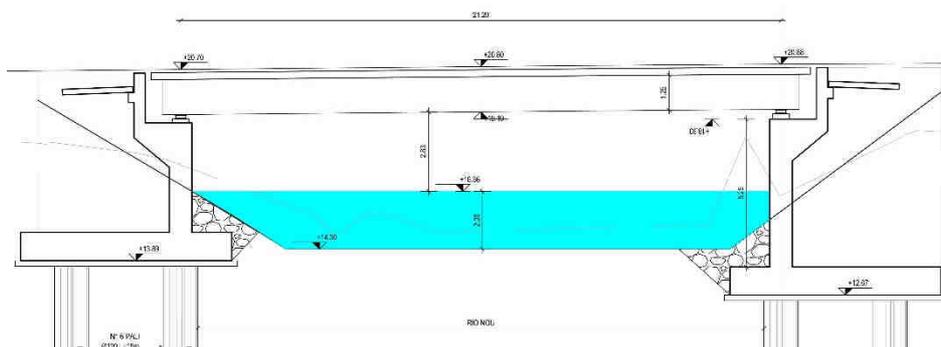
Attraversamento Rio IS Nou - ponte secondario PO.05 su complanare S05
